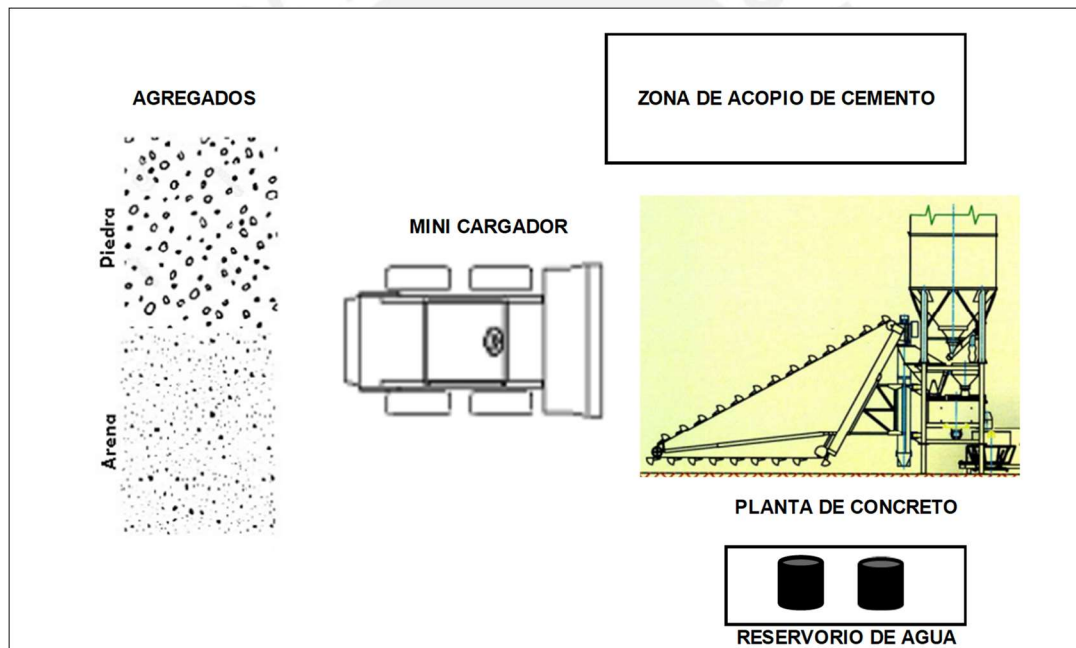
Distribución de Planta de Concreto (Fuente propia)
